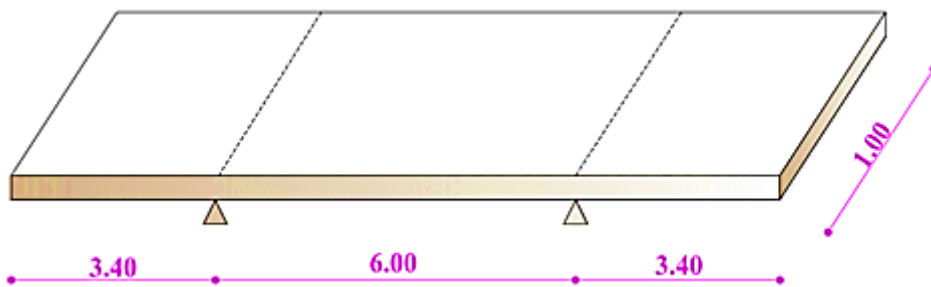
Modèle poutre sur deux appuis (h=0.40 m et b= 1.00m)
